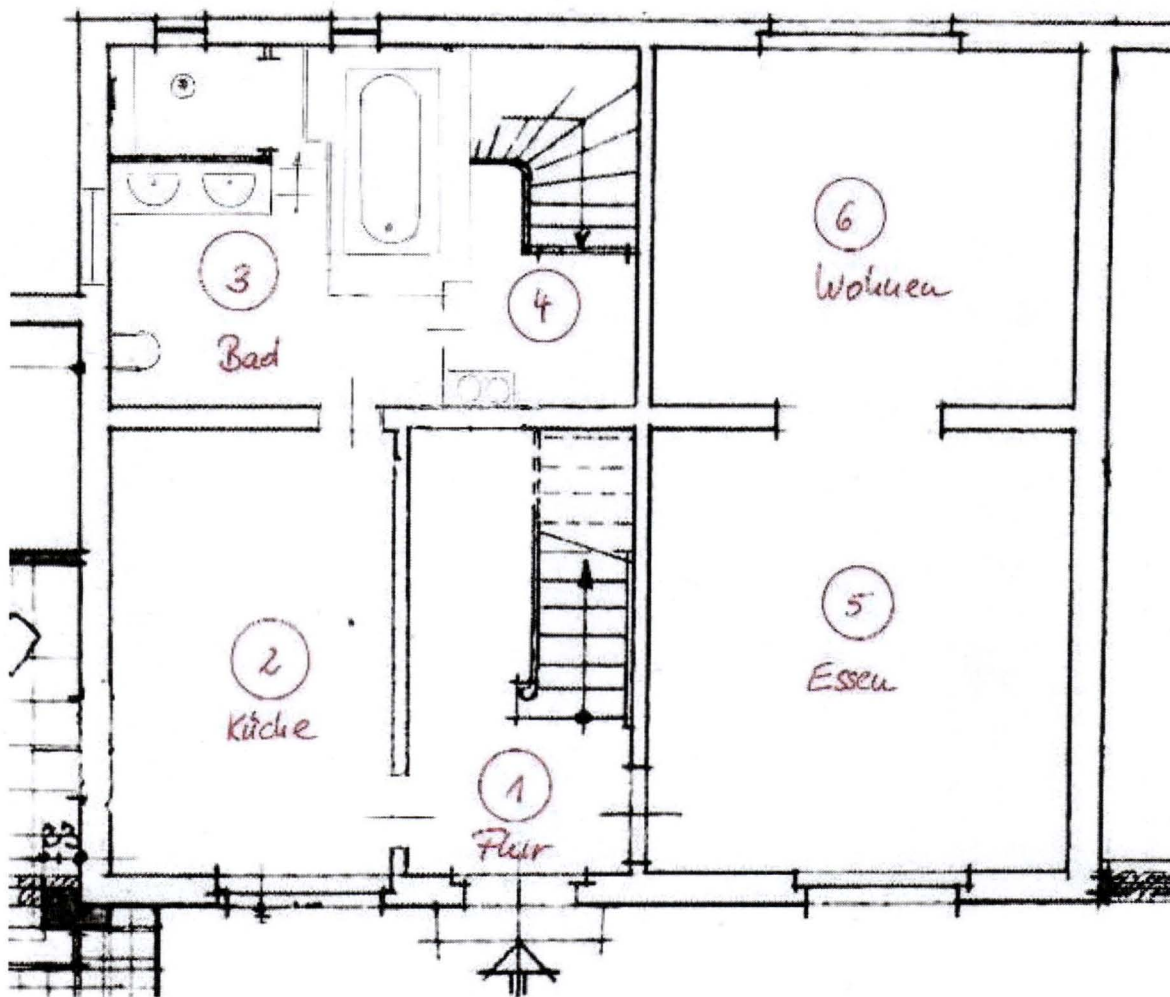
Wohnhaus, Grundriss EG
